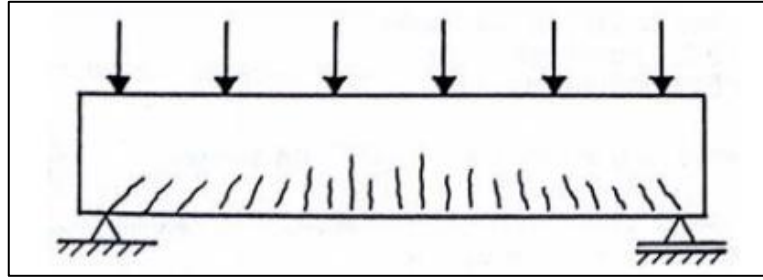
Fissuração típica em viga solicitada à flexão
